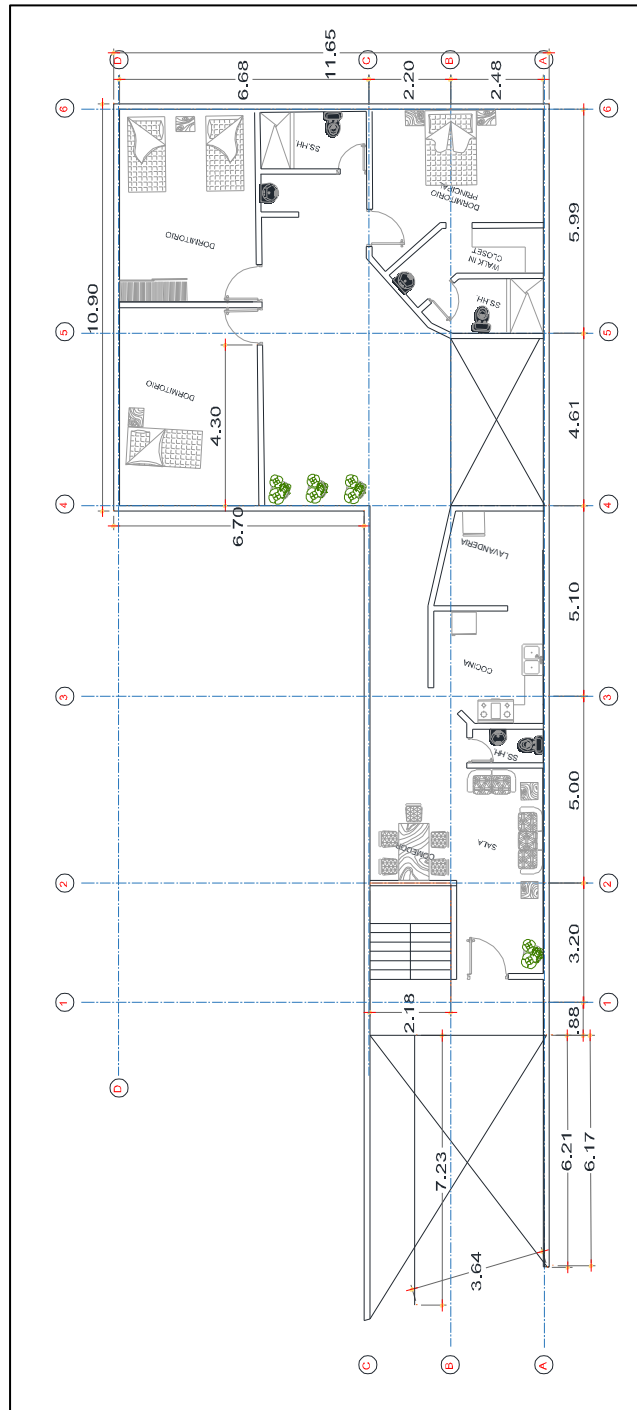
Plano de arquitectura típica que se usará en el proyecto para el modelamiento estructural. Fuente propia
